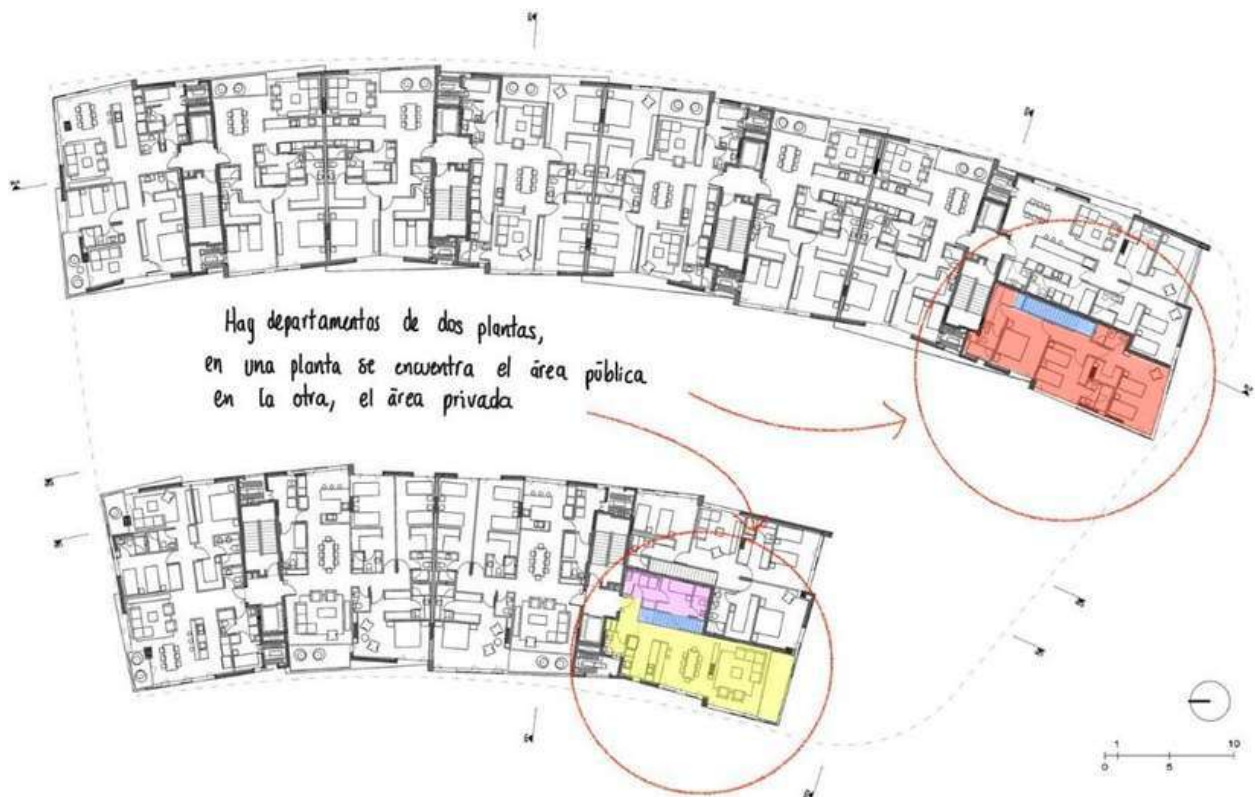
Planta arquitectónica intervenida con zonificación. Fuente: Autoría propia.
